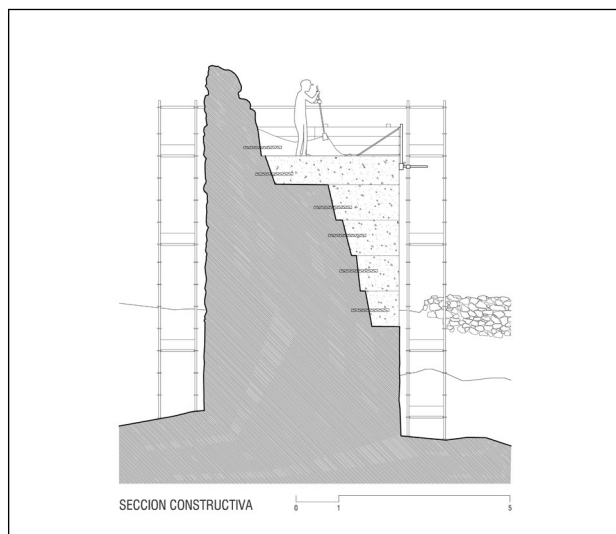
Sección de la torre que indica el proceso constructivo de la restauración
